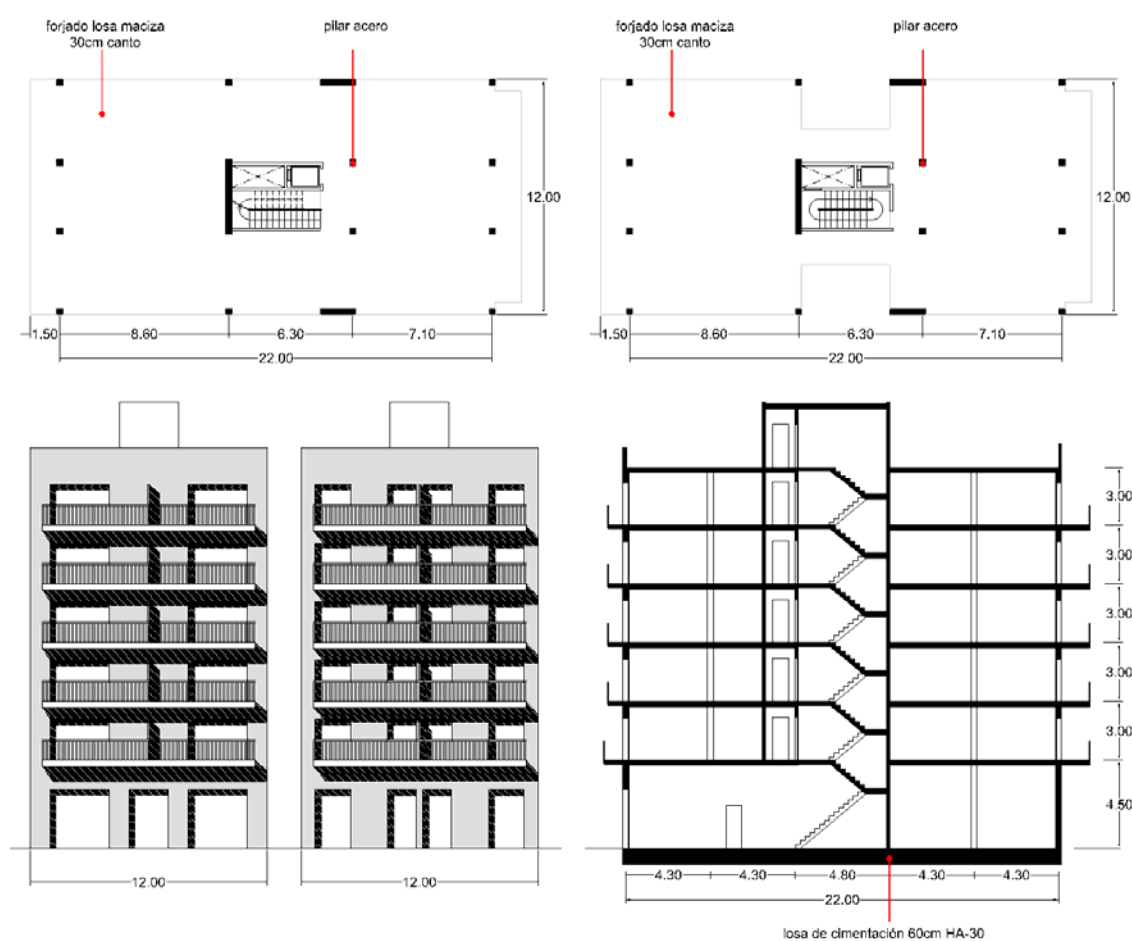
k Plantas, alzados y sección del modelo IV.5
